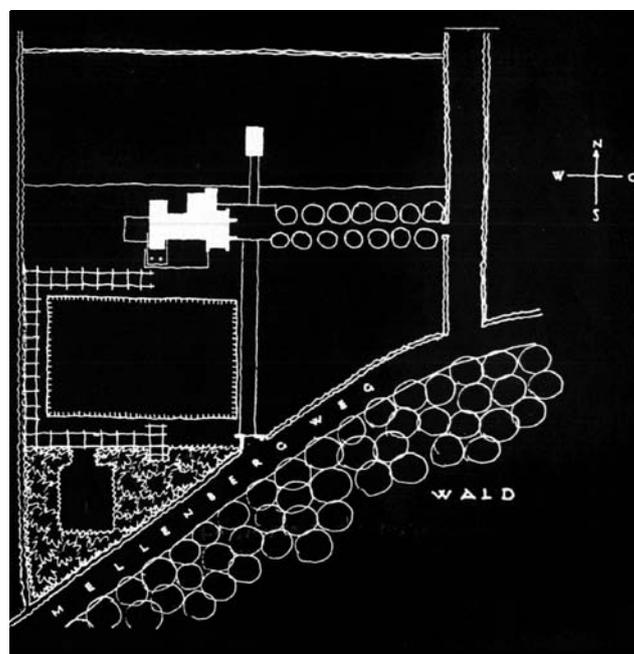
Haus Schluck, Lageplan, Zeichnung der Architekten
